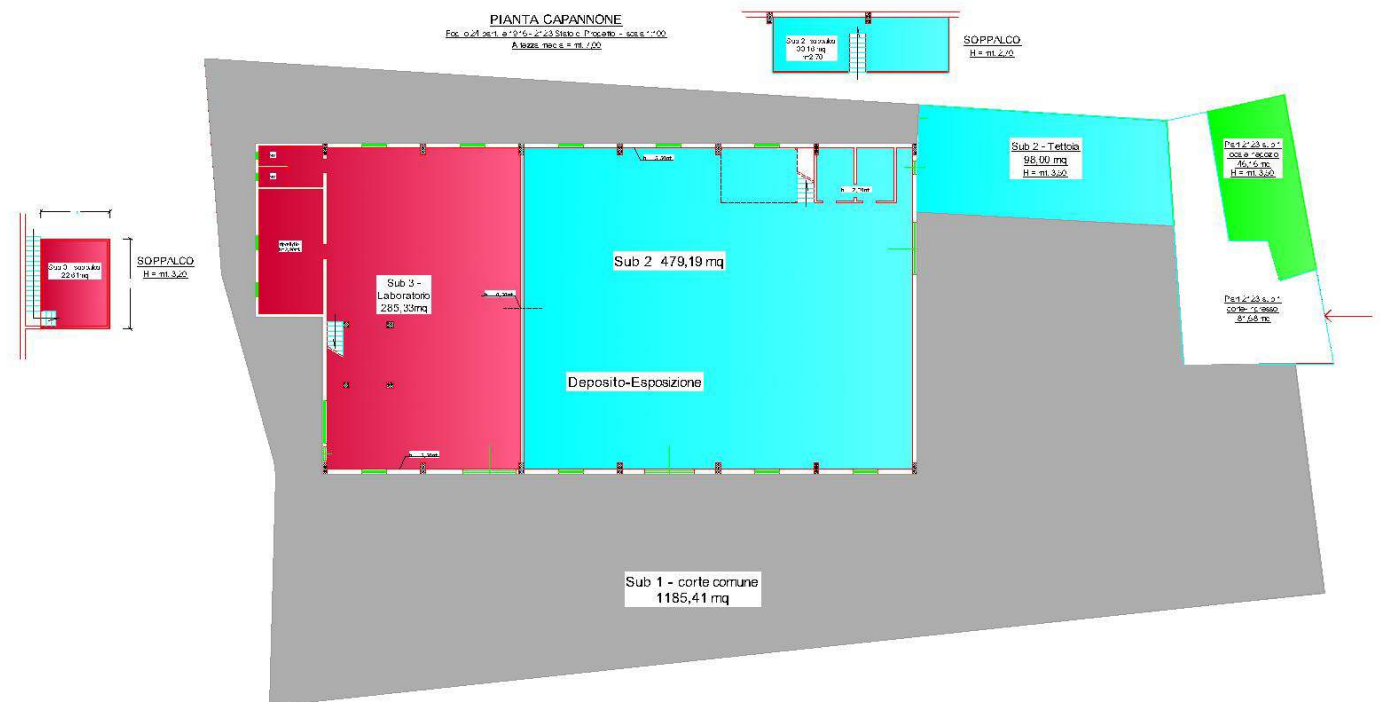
Planimetria Lotto 1 – Capannone in Via Delle Americhe – Siderno (RC)
